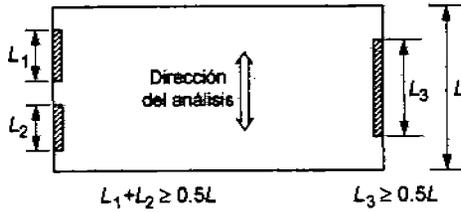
REQUISITOS SOBRE MUROS DE CARGA PERIMETRALES PARALELOS
